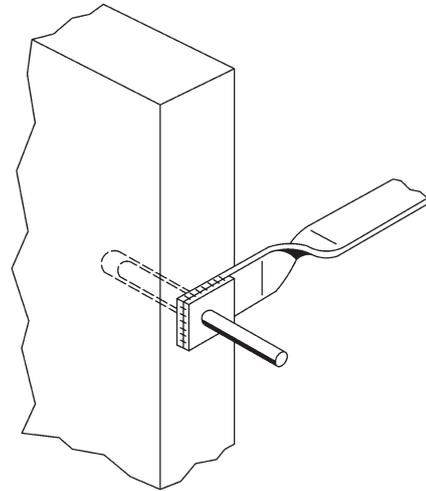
Halteanker gedreht mit Anschweissdorn.
